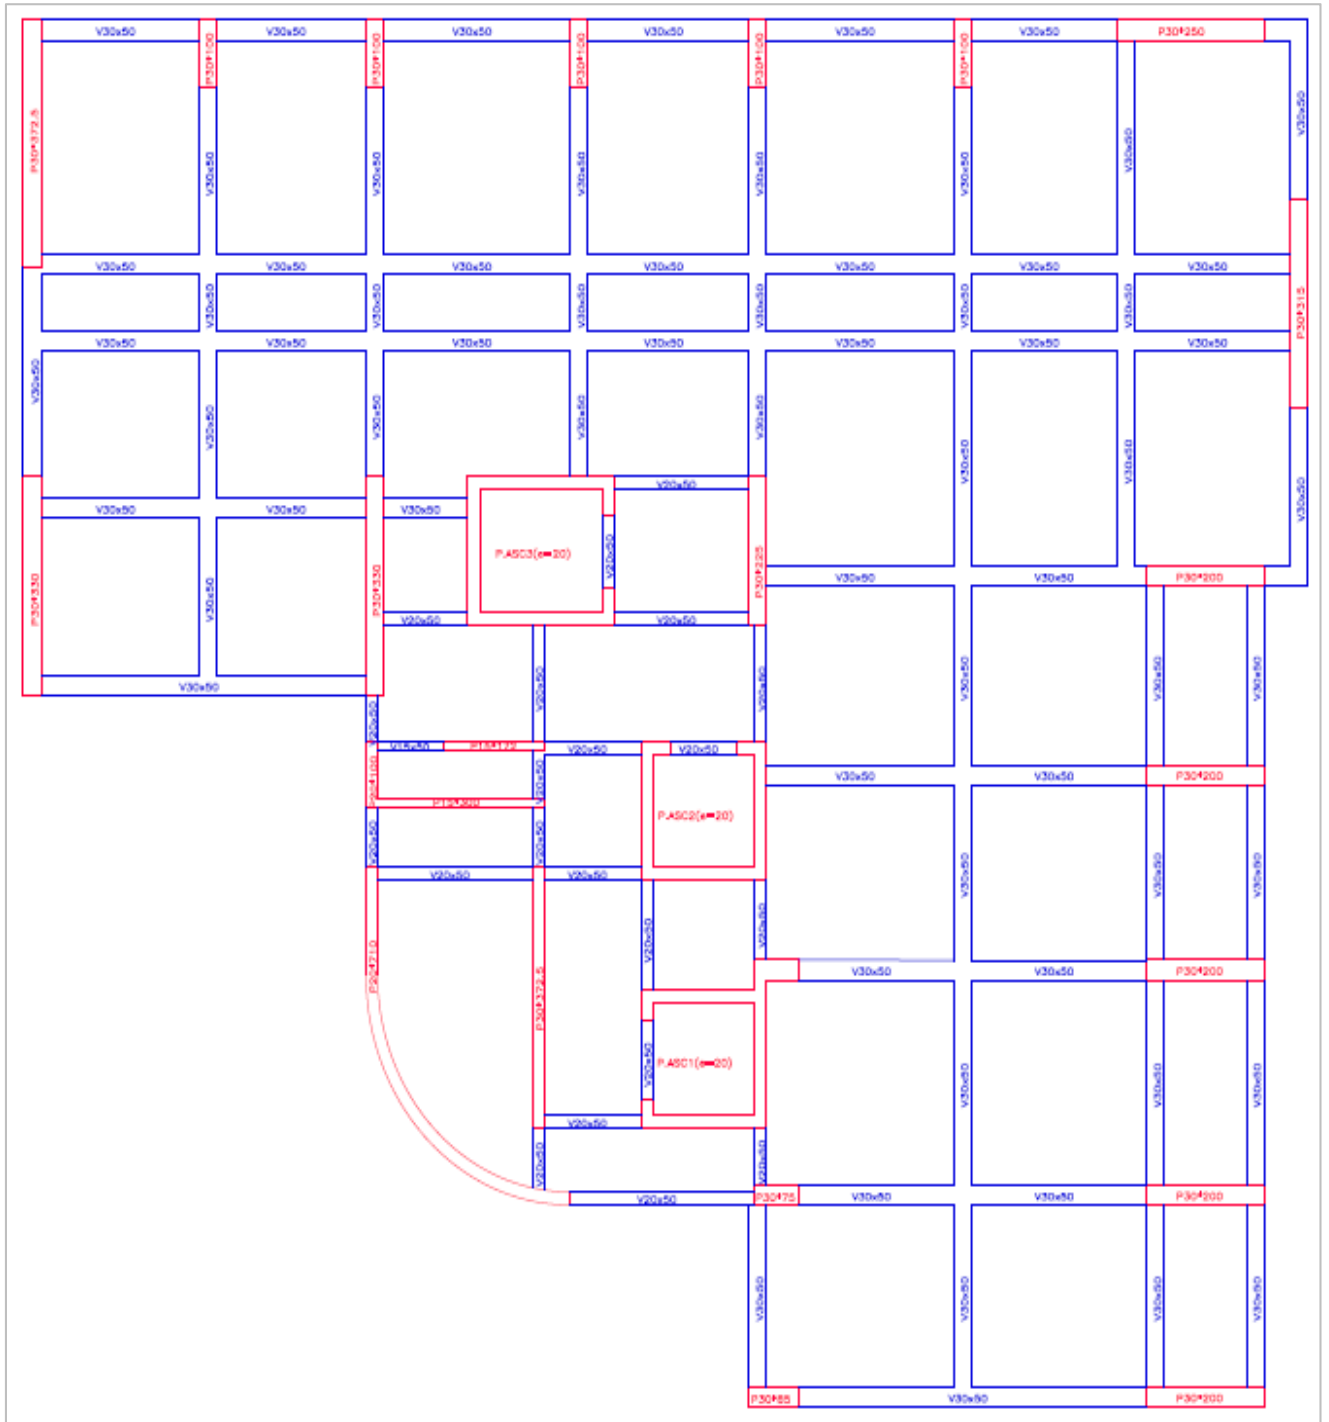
Esquema de Estructuración en Planta - Piso 2 a Piso 21
